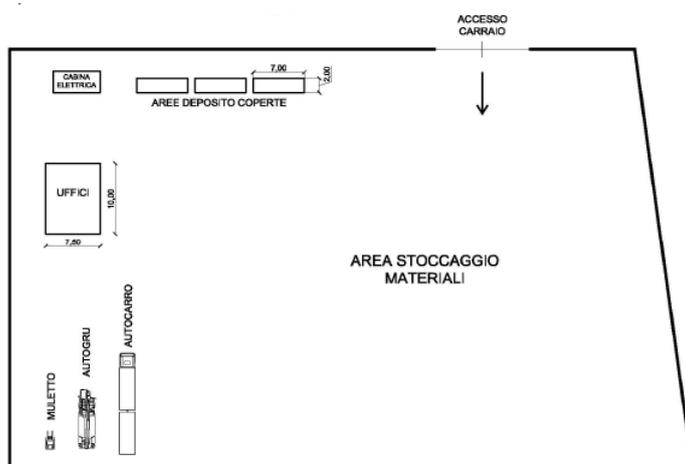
Tipologico del layout dell'area centrale di cantiere
